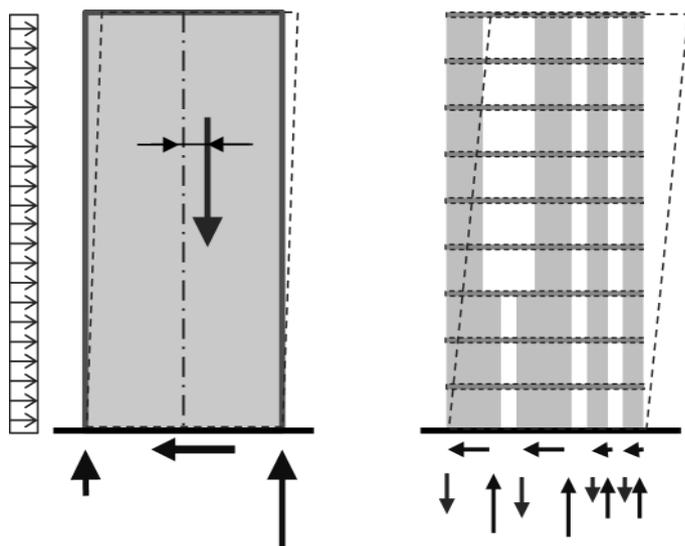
Structure monolithique et rigide; structure avec assemblages non rigides, et soumis à un glissement
